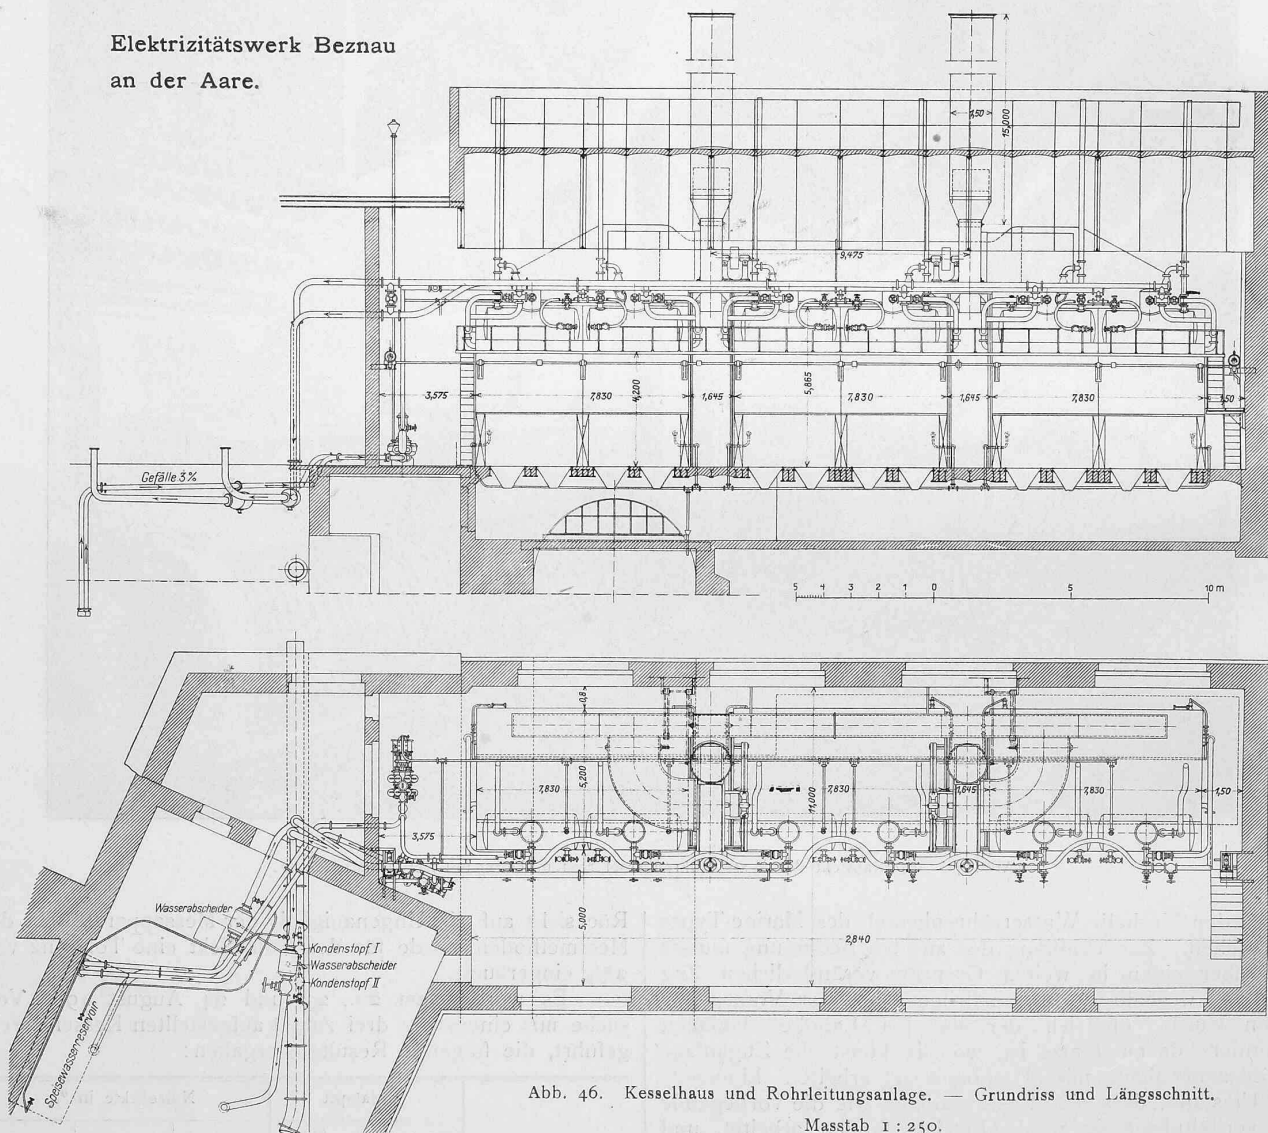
Kesselhaus und Rohrleitungsanlage. — Grundriss und Längsschnitt.
